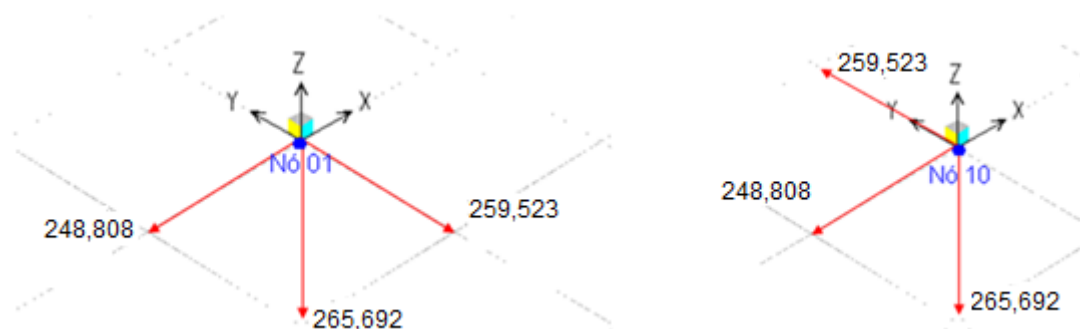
Carregamento dos pilares de sustentação da estrutura de cobertura – nó 01 e nó 10.
